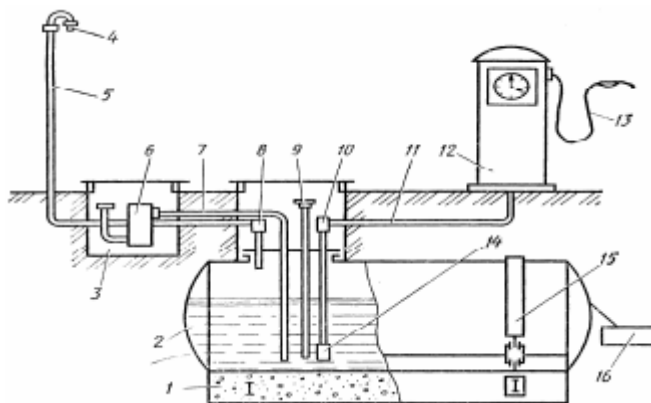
Стаціонарна АЗС: 1 - бетонна основа (фундамент);
